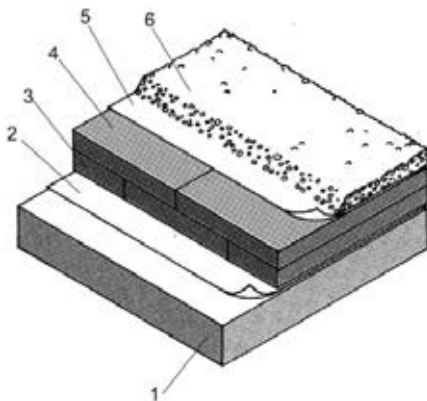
Утеплення плоского даху: 1 — залізобетонна плита; 2 — підпокрівельна гідроізоляція; 3 – теплоізолюючі плити; 4 – додаткова теплоізоляція; 5 – підпокрівельна гідроізоляція; 6 – шар гравію.
